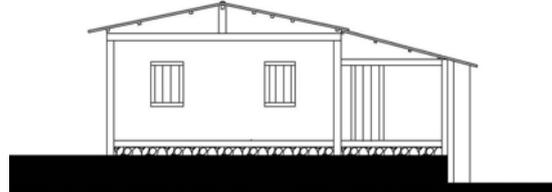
Fachada Leste (Acervo PROAU/FAU/UnB).
